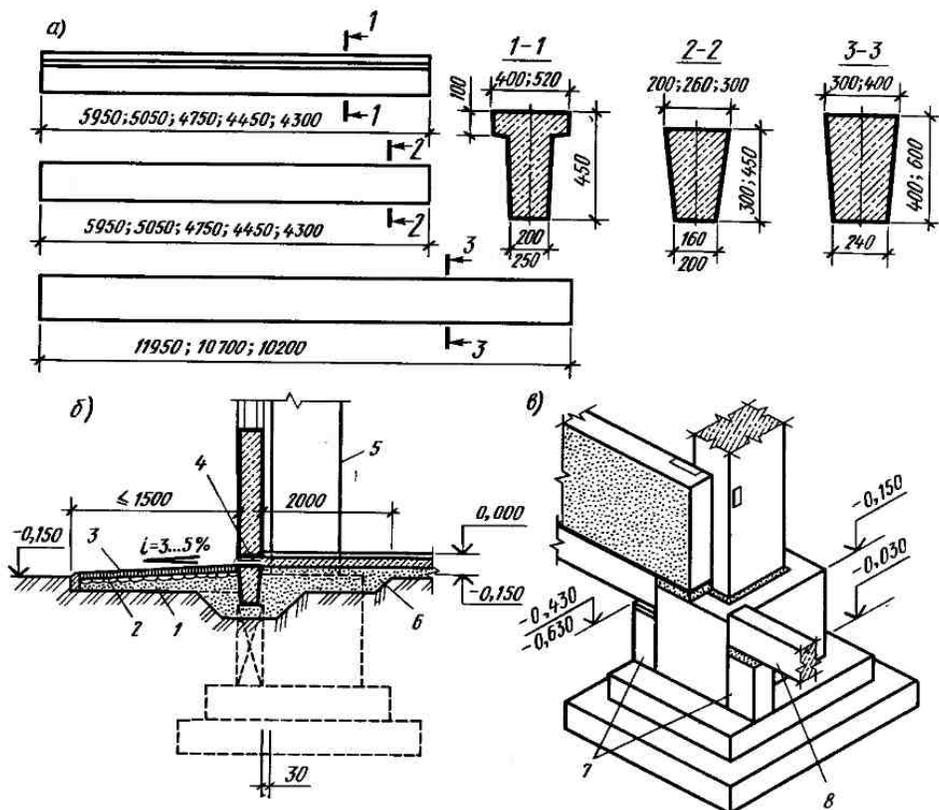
Детали фундаментов крайнего ряда колонн:
